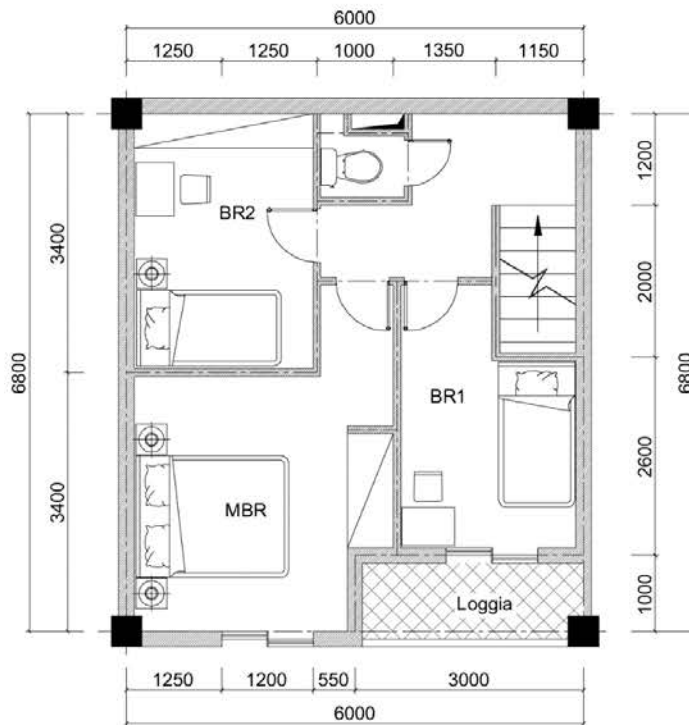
中層住宅住戸平面図（単身労働者向けタイプ）（将来の改築プラン）
